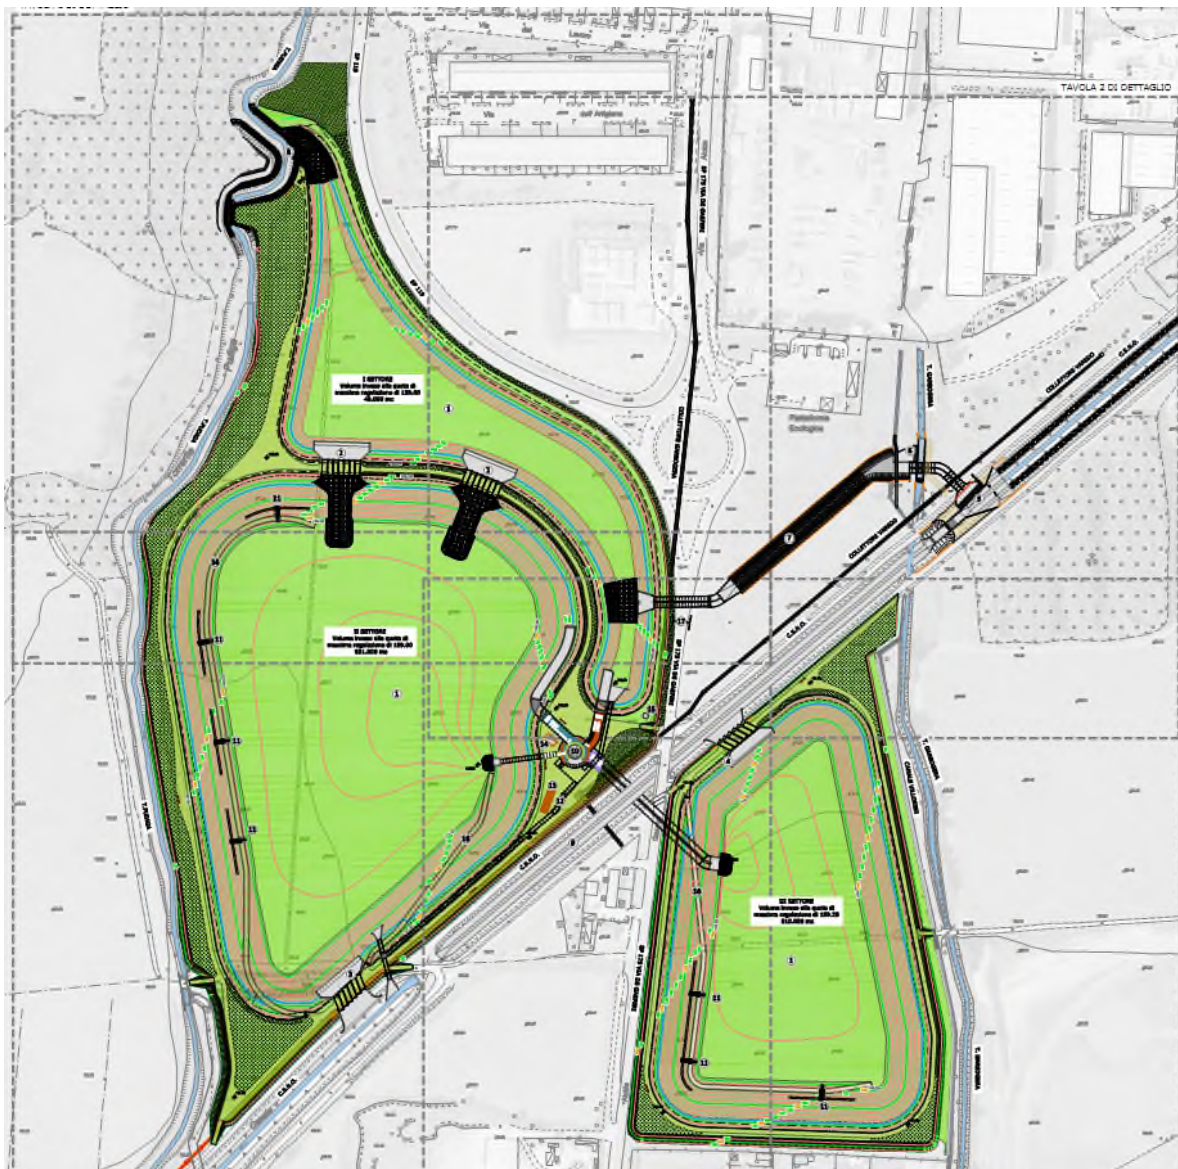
Estratto della planimetria generale nella configurazione del Progetto Esecutivo
